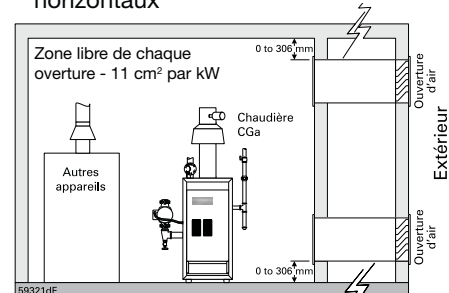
Air provenant de l'extérieur – conduits horizontaux
